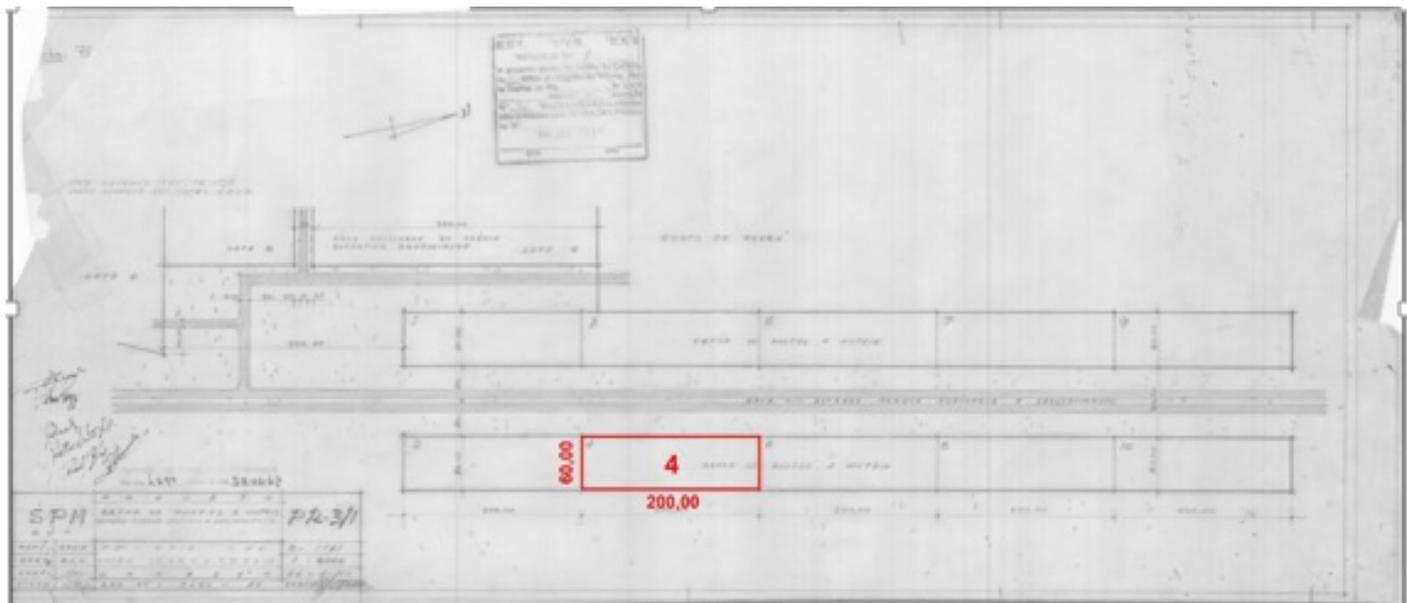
Lote 4 original aprovado e registrado na Planta SPM/S PR-3/1
